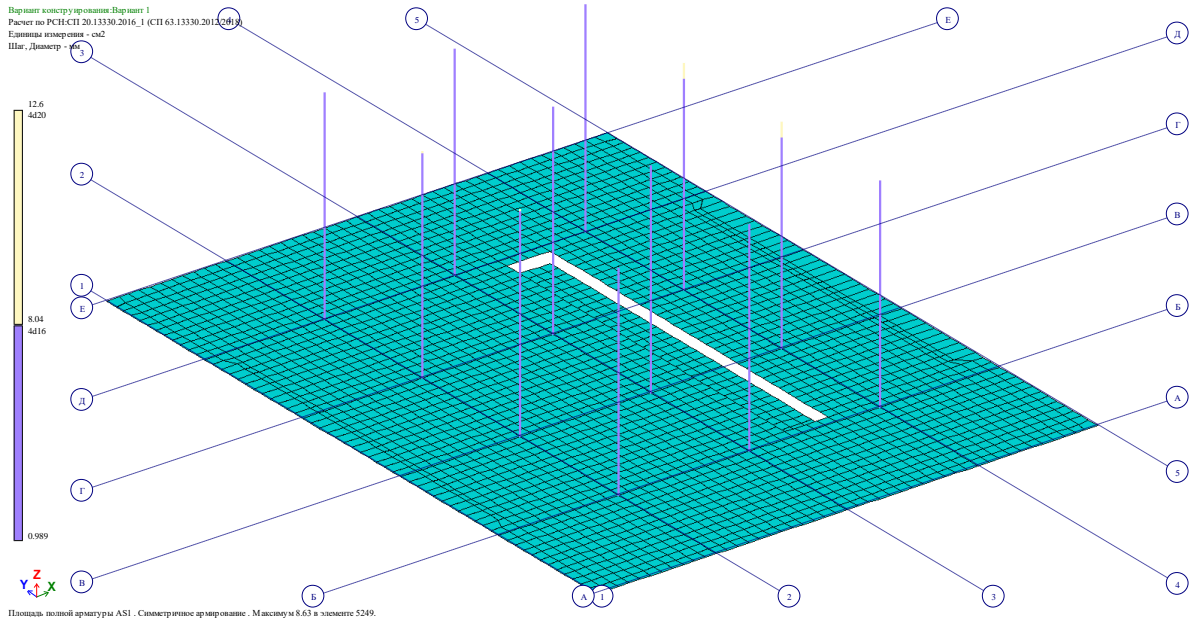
Площадь арматуры колонны (AS1, AS2).
